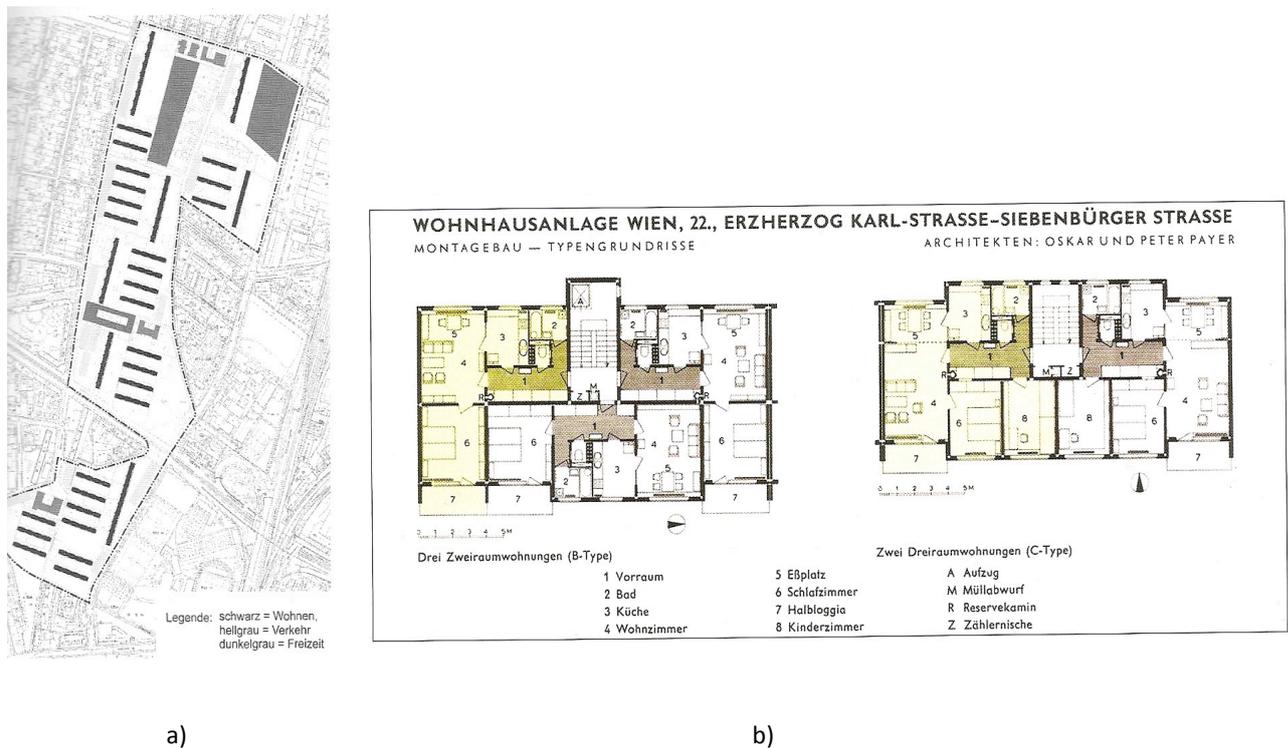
a) Bebauungsform der Siedlung Siebenbürgerstraße (Wien 22), b) Grundriss der Haustypen B und C [2]
